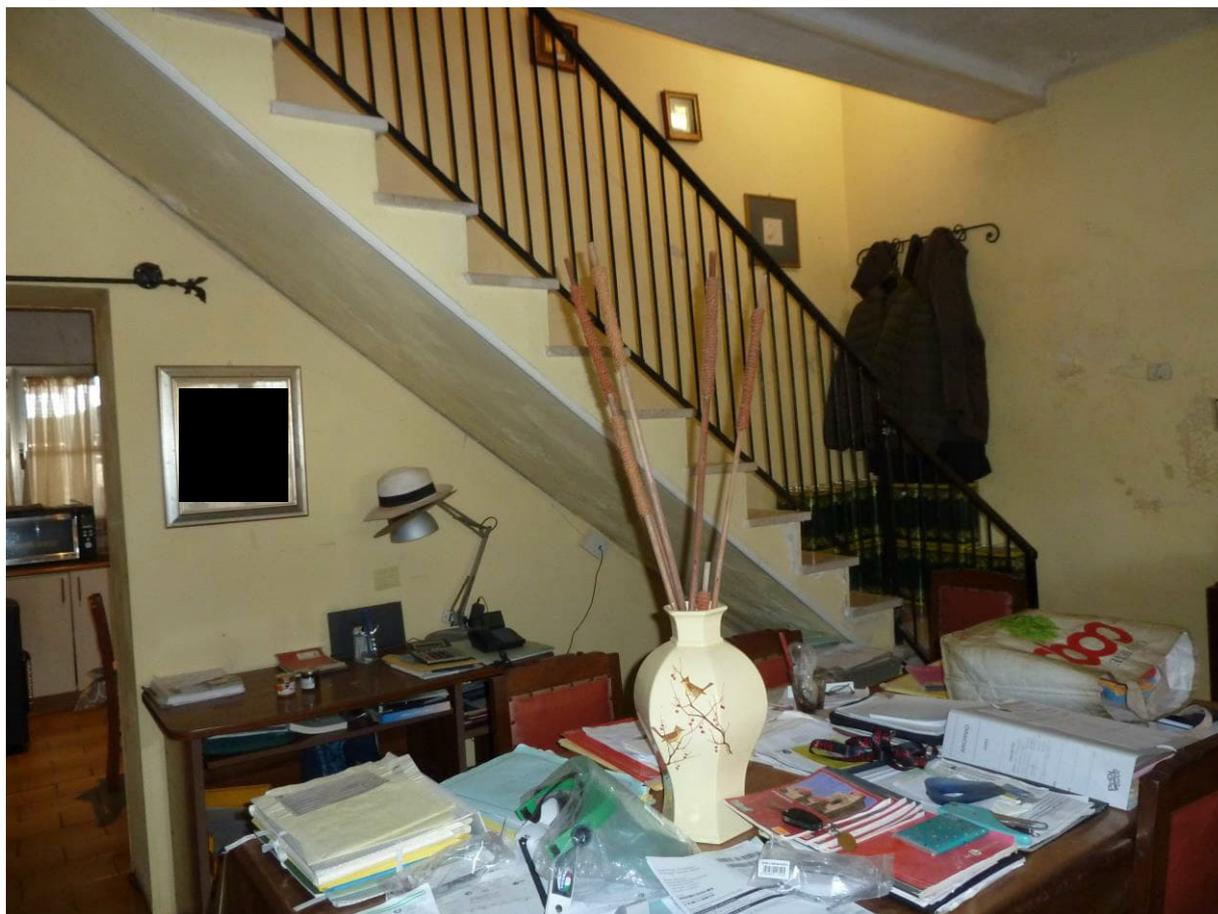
Veduta del piano terra dell'abitazione e della scalinata di accesso al primo piano
